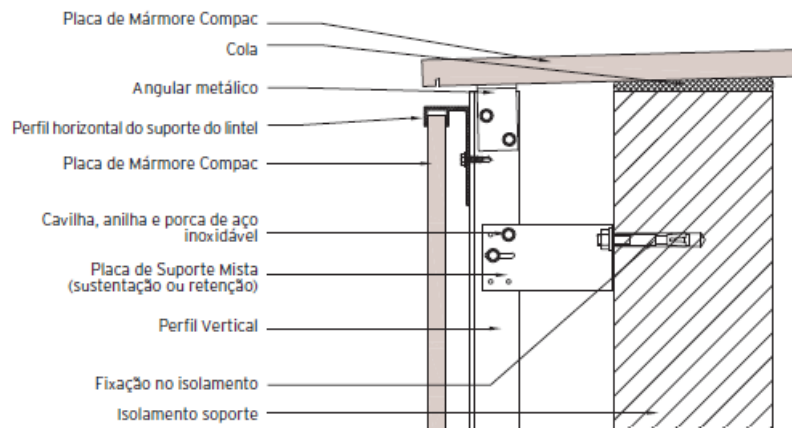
Detalhe construtivo de remate superior – coroamento [79].
